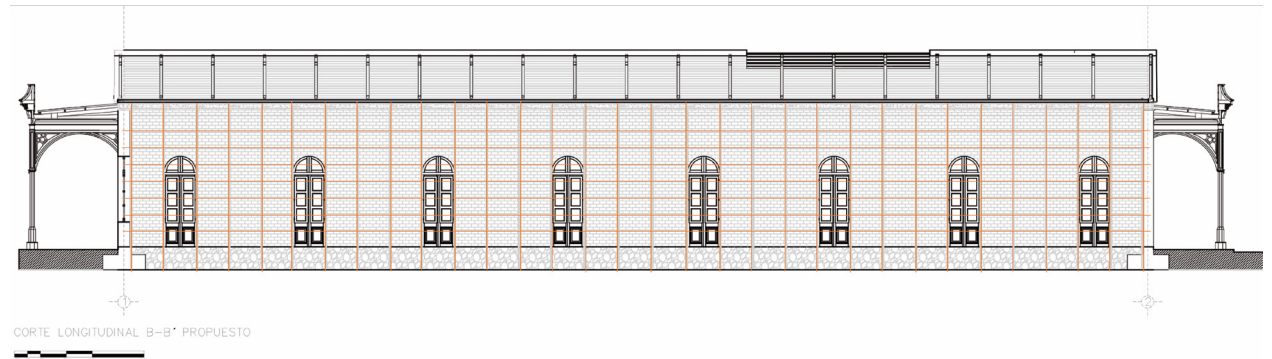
Embebido de Acero de Refuerzo en Albañilería Figura Esquemática
